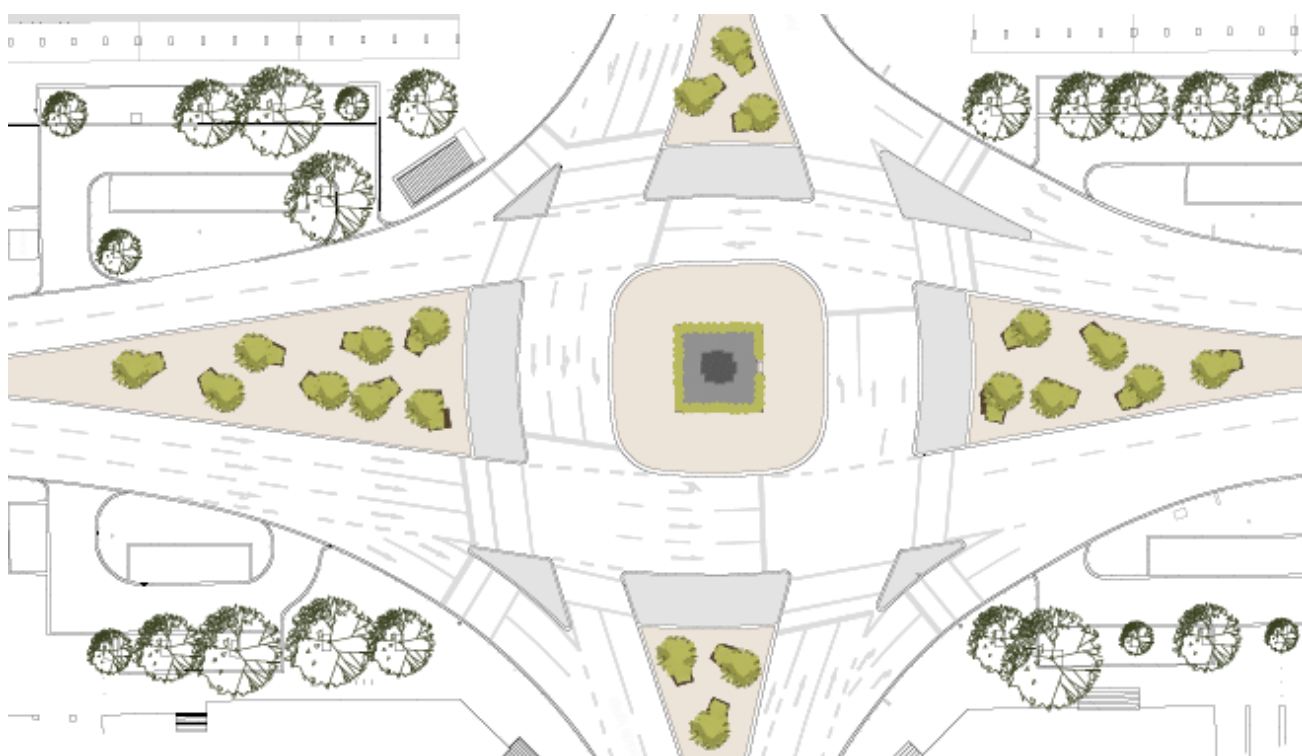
Pormenor do estudo prévio para a Praça de Alvalade
